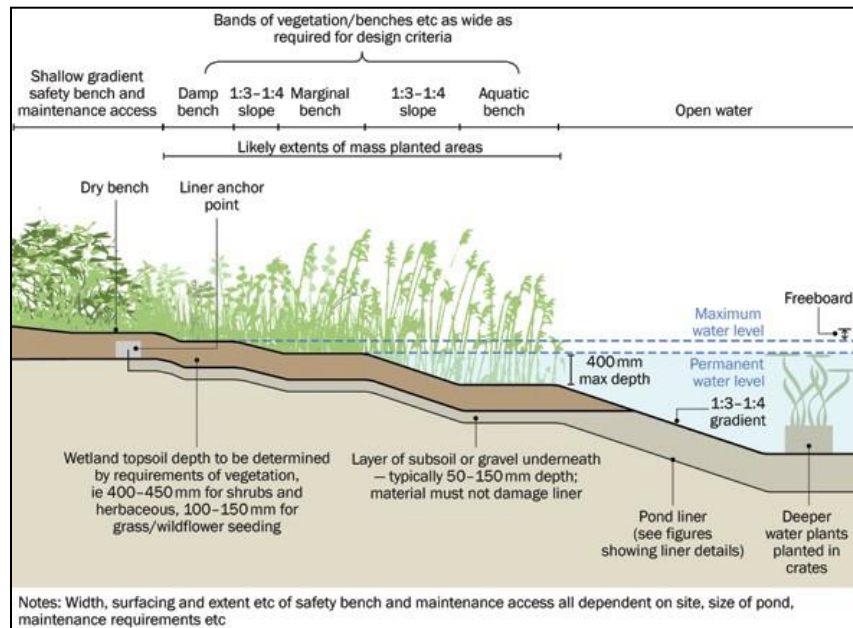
Detalles típicos del borde de la Laguna plantada
